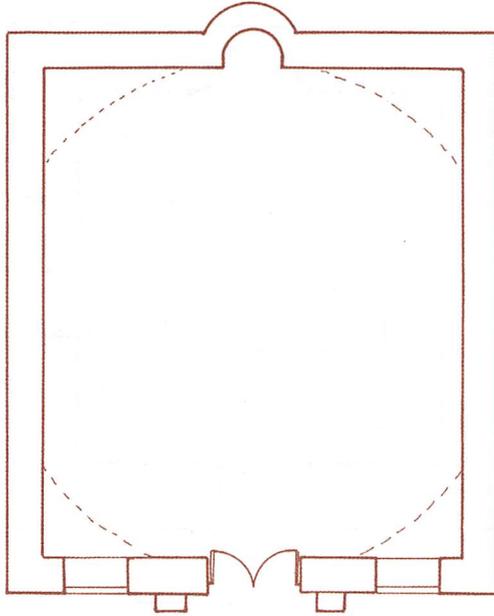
ب) : المسقط الأفقي لقبة وضريح حمودة بالرحمانية
